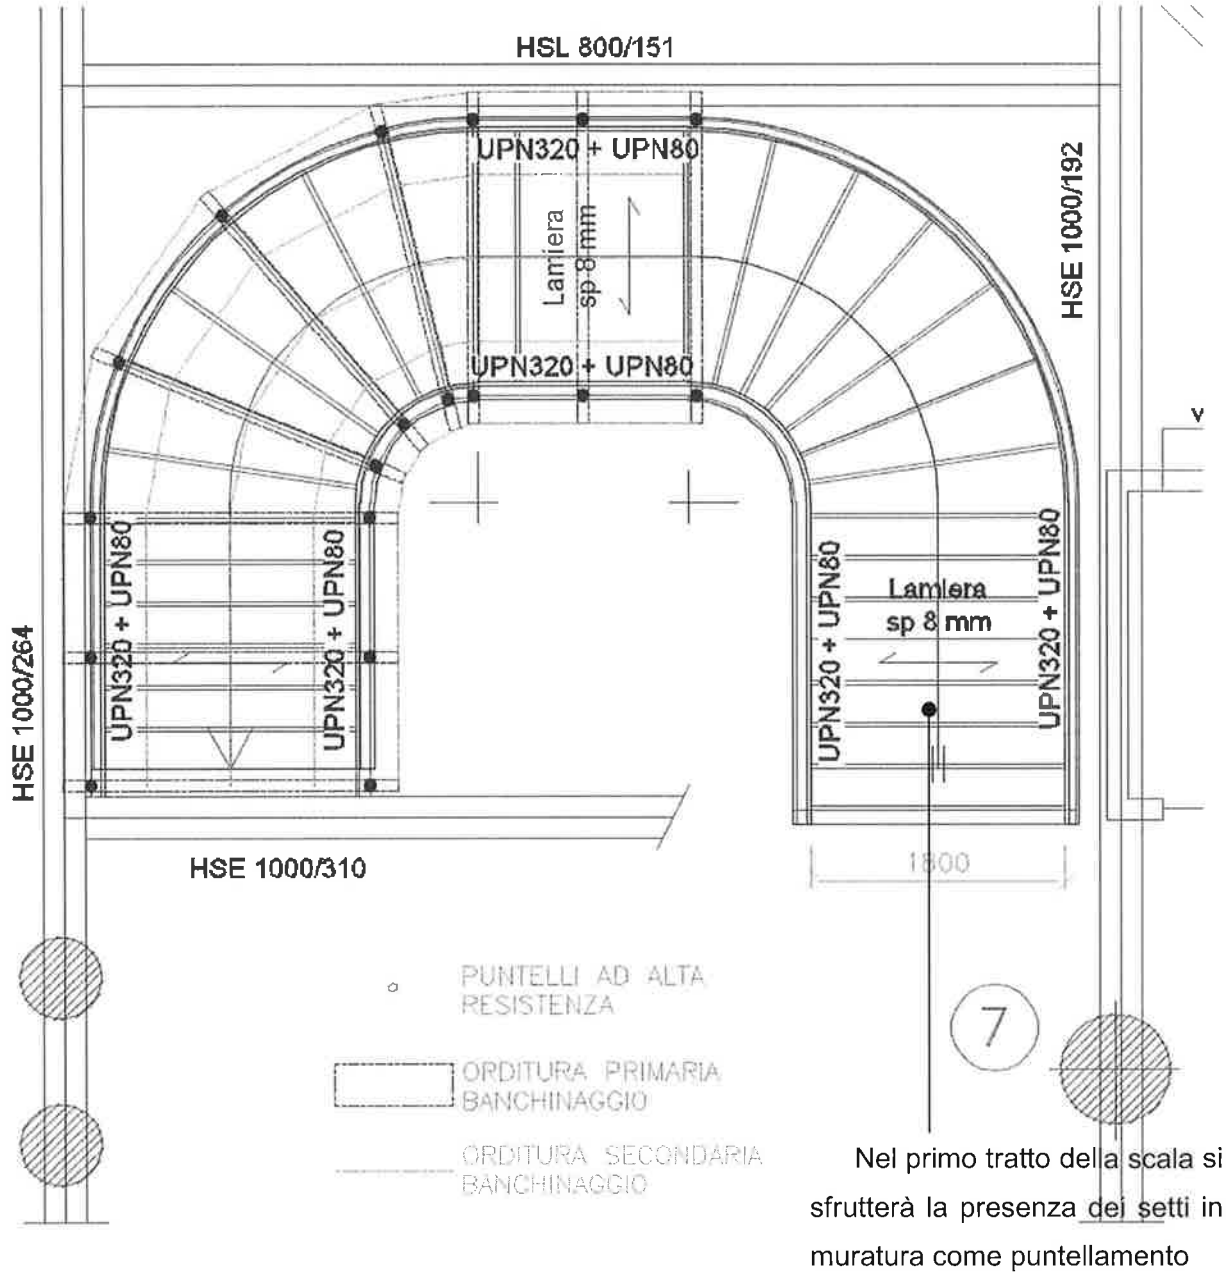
, esempio, sistema di banchinaggio prefabbricato
